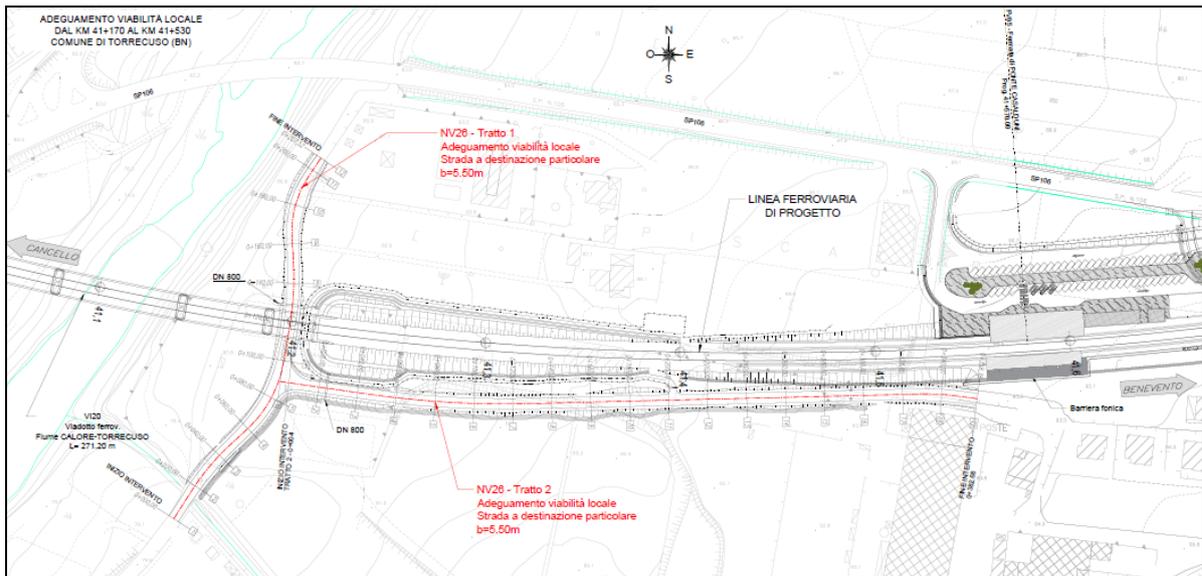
Contesto di analisi B - Stralcio planimetria PD
